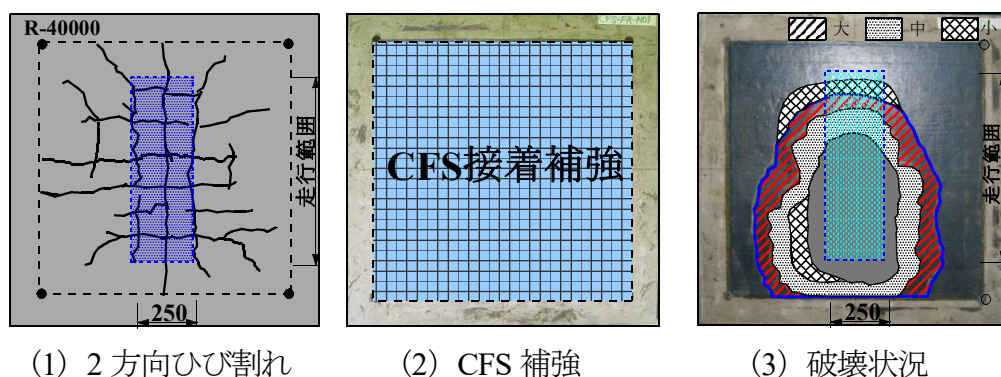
2方向ひび割れ発生後CFS 補強床版 RC.D-C の破壊状況
